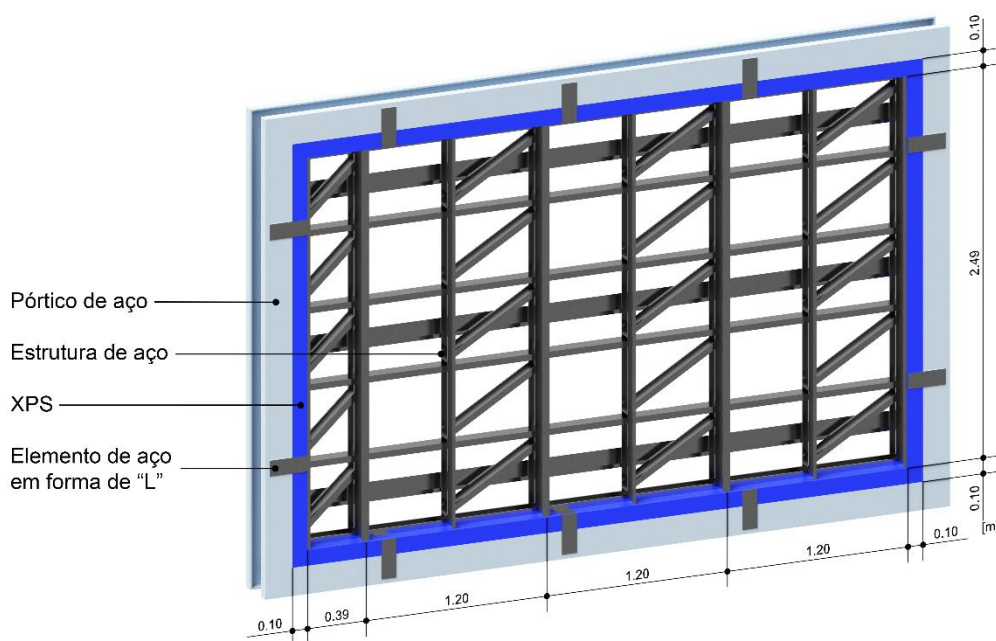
Estrutura de aço dos módulos de parede e pórtico da câmara de ensaios.
